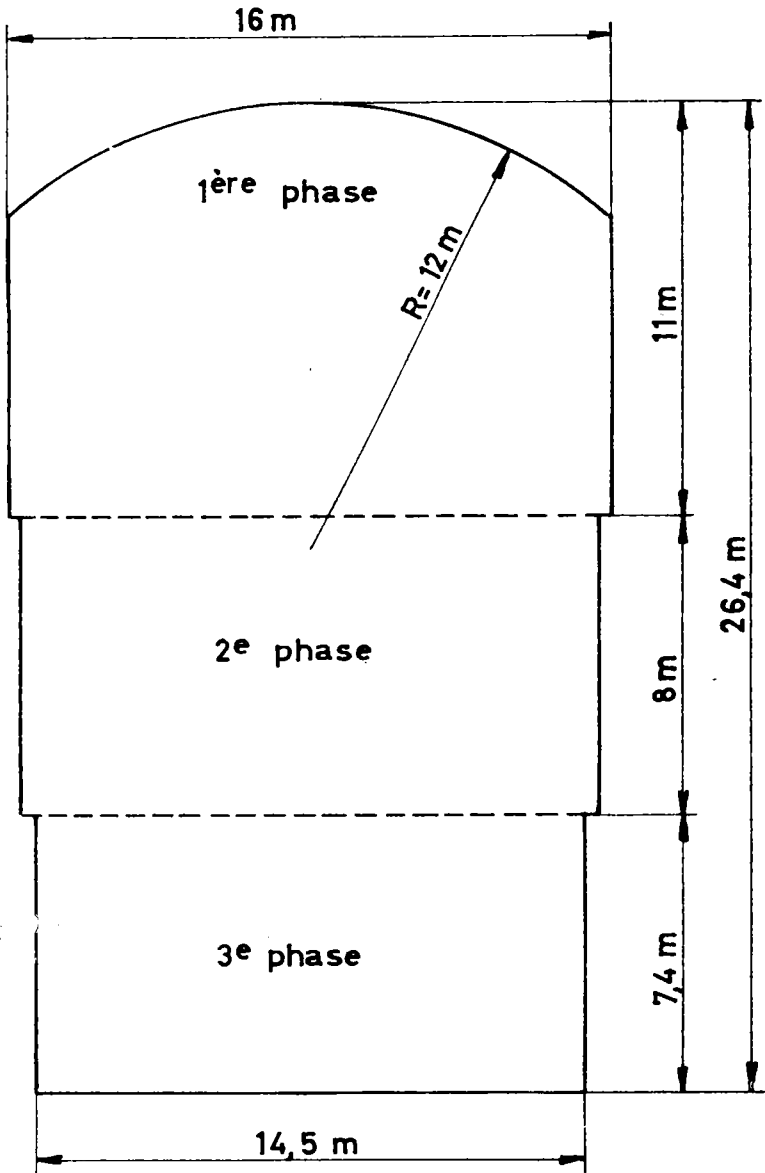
Coupe transversale du tunnel de Stornörrfors.
